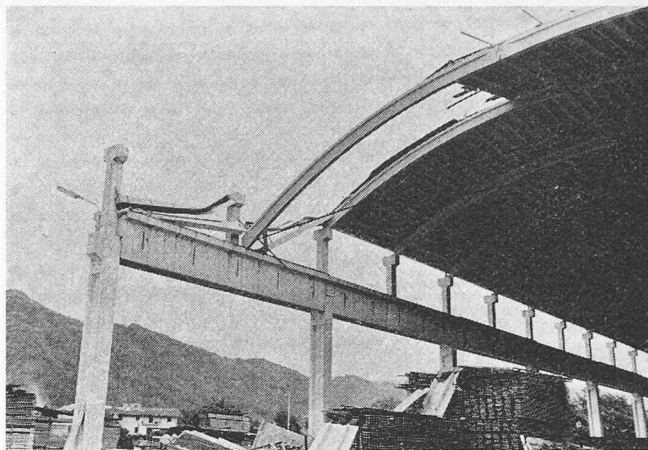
Offene Halle aus vorfabrizierten Stahlbetonelementen südlich Magnano. Dachbinder als Dreigelenkbogen mit Zugband auf Stützen aufgelegt. Einsturz eines Dachsegments und Beschädigung eines weiteren Segments infolge Abgleiten des Binders ab dem Auflager
